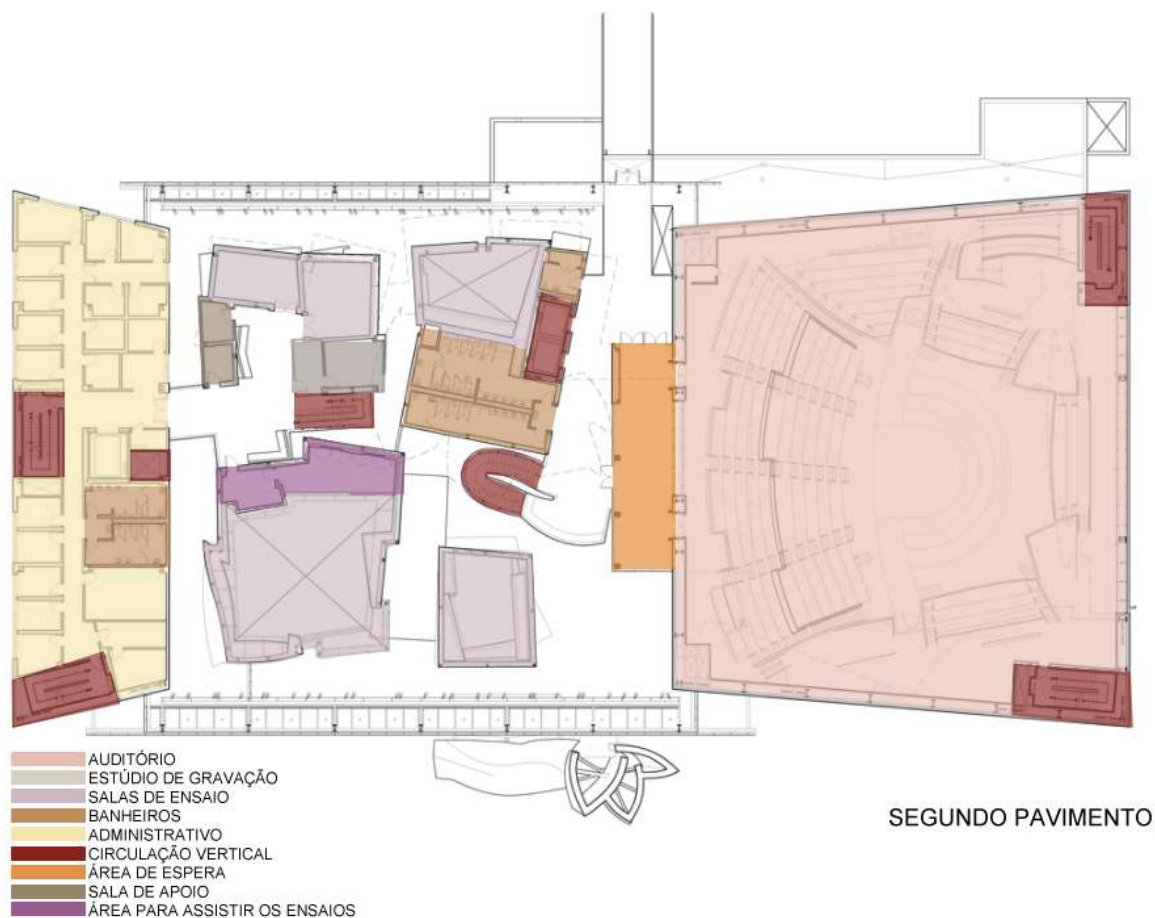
Planta segundo pavimento. Fonte: ArchDaily editada pela autora.
